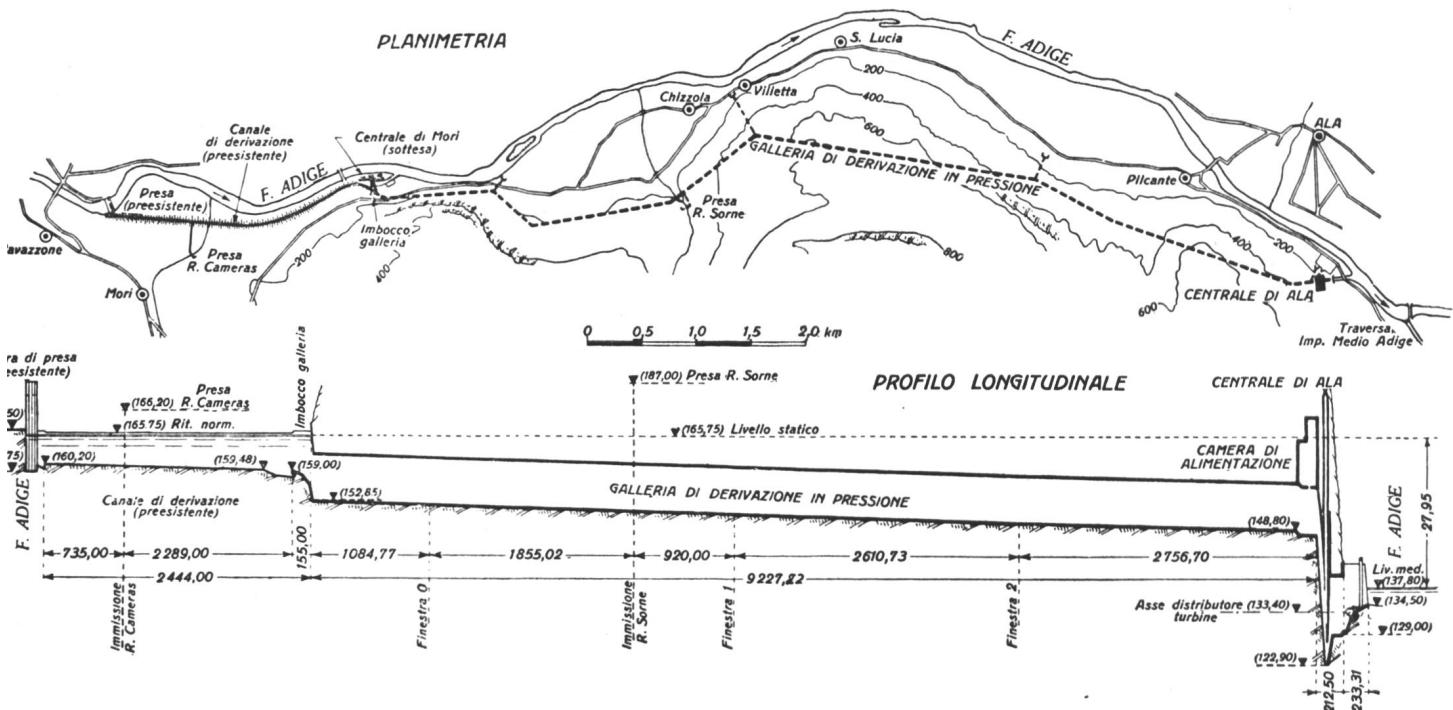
Kraftwerk Ala an der Etsch, Lageplan und Längsschnitt
